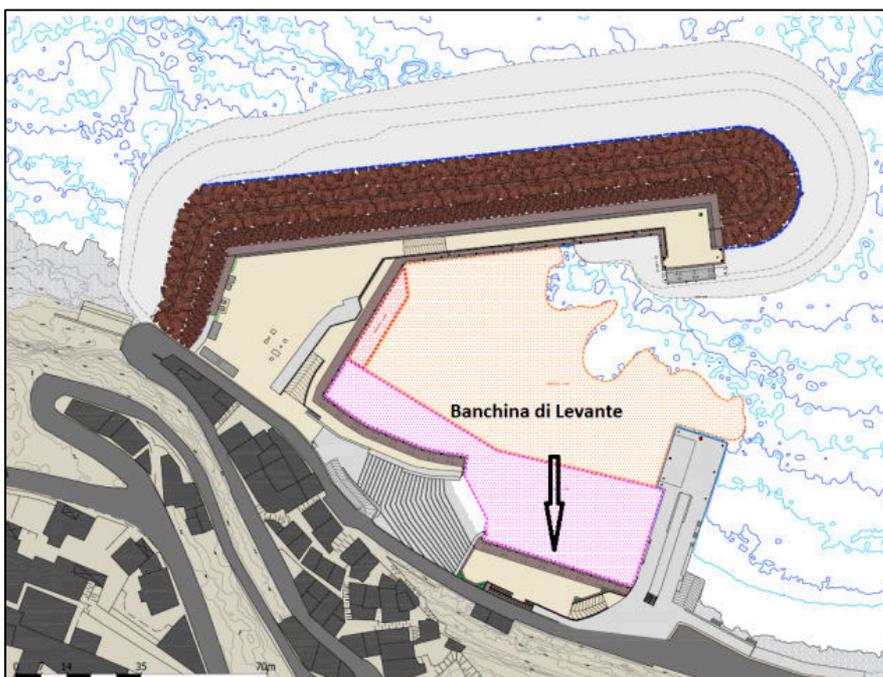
Planimetria generale delle opere in variante con indicazione della banchina di levante
